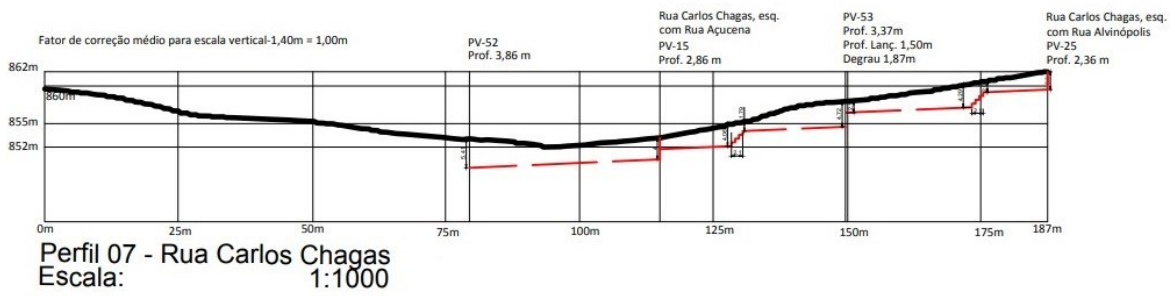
Perfil longitudinal da rua Carlos Chagas
